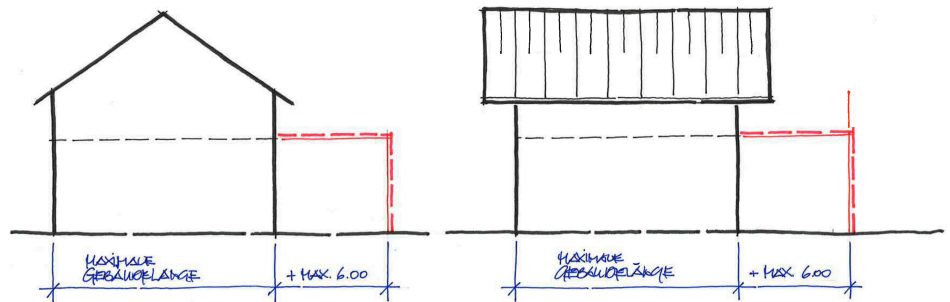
Schema zur Mehr-Gebäudelänge in den Zonen W1 und W2 (ohne Masstab)
